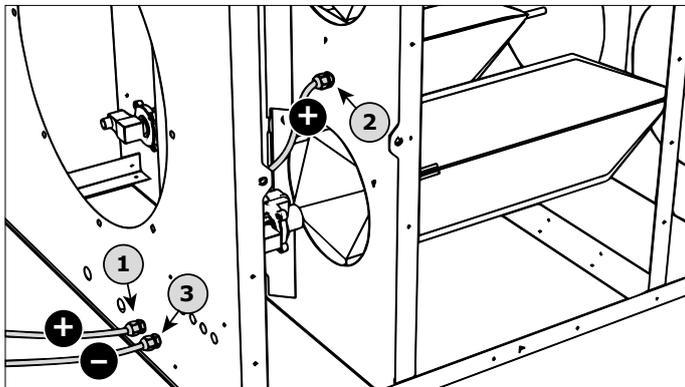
Kabelverschraubungen und Pneumatikschläuche
